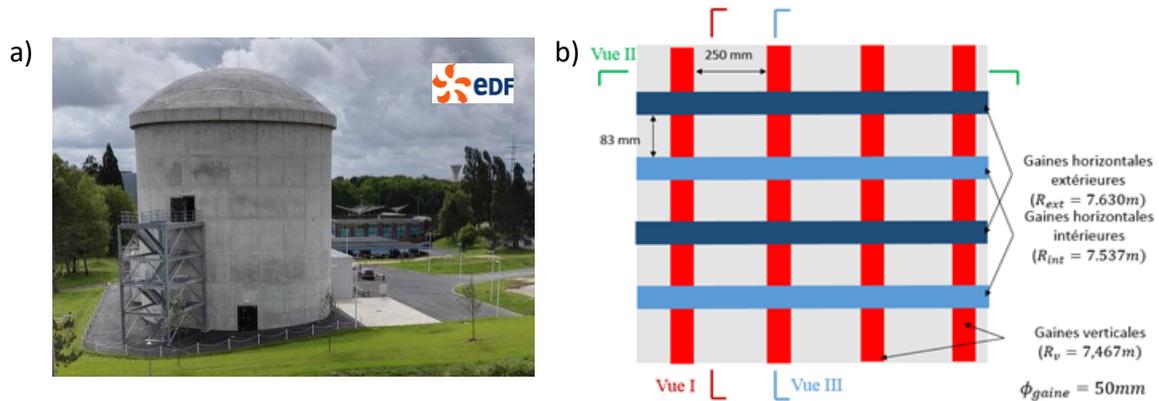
a) Structure VERCORS en vue extérieur - b) Exemple de plan de ferrailage de l'ouvrage
